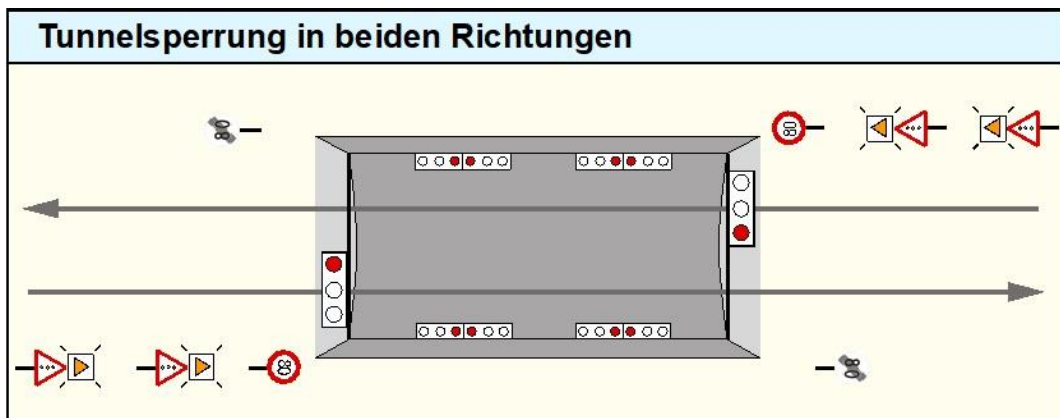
BZ – Tunnelsperrung in beiden Richtungen.
